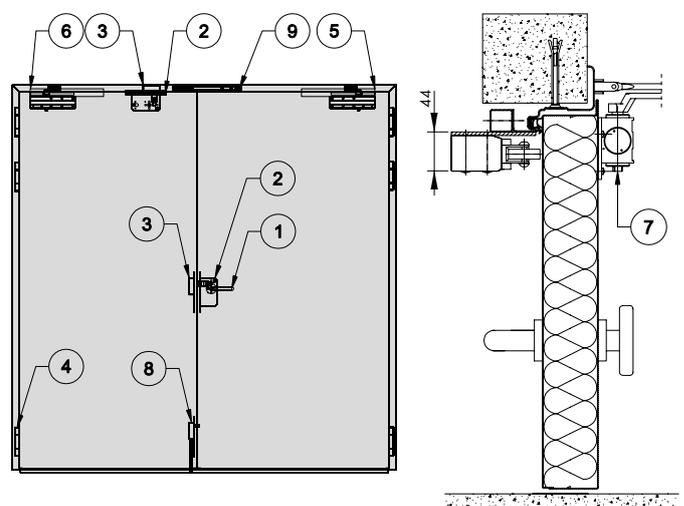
Schema zweiflügeliger Türen - Vertikalschnitt mit Belüftungssystem.
